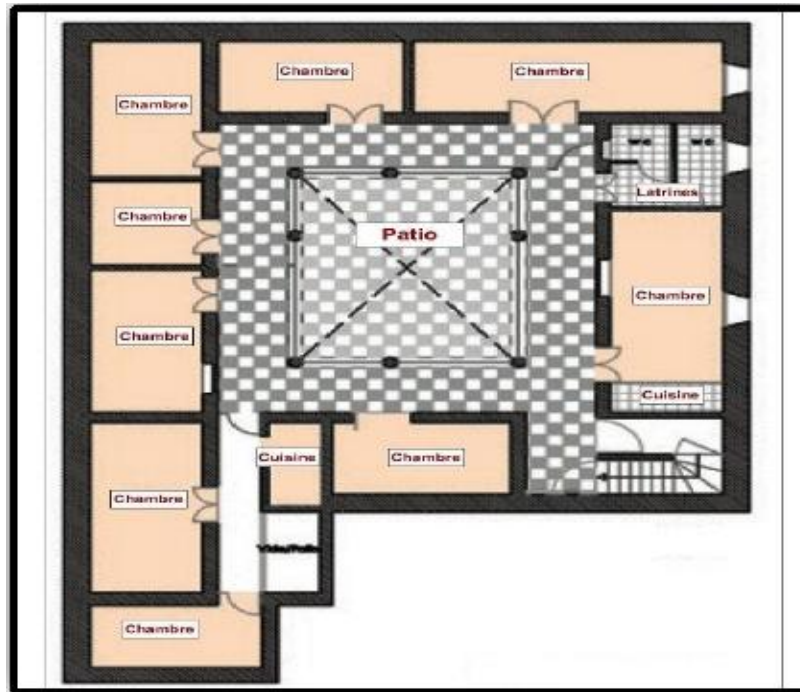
Relevé architectural de la maison03, quartier Mellah).
